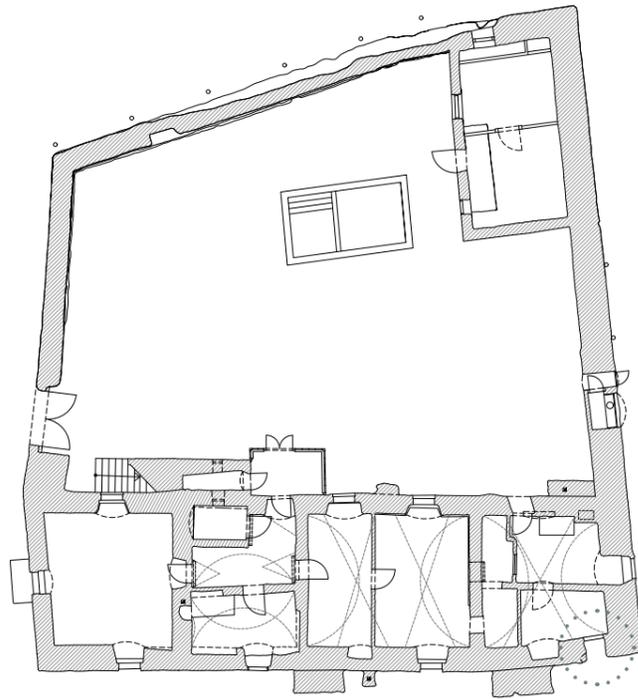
Lage Zugang zu ehemaliger Kellertreppe, Grundriss Erdgeschoß
